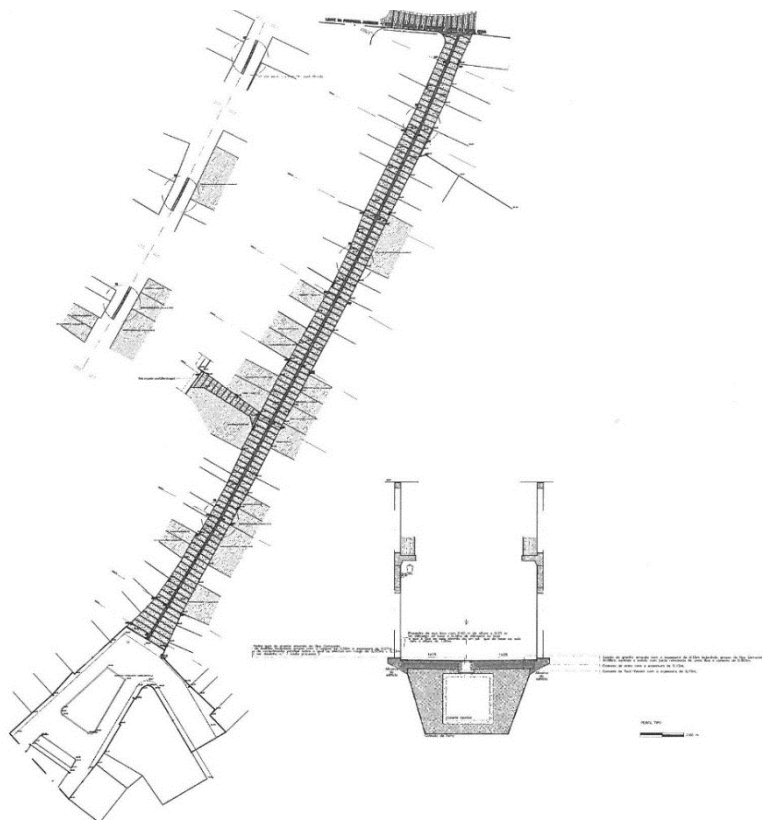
Projeto de Execução para a remodelação da Rua D. António Barroso (Rua Direita) Planta e Perfil, S/E
